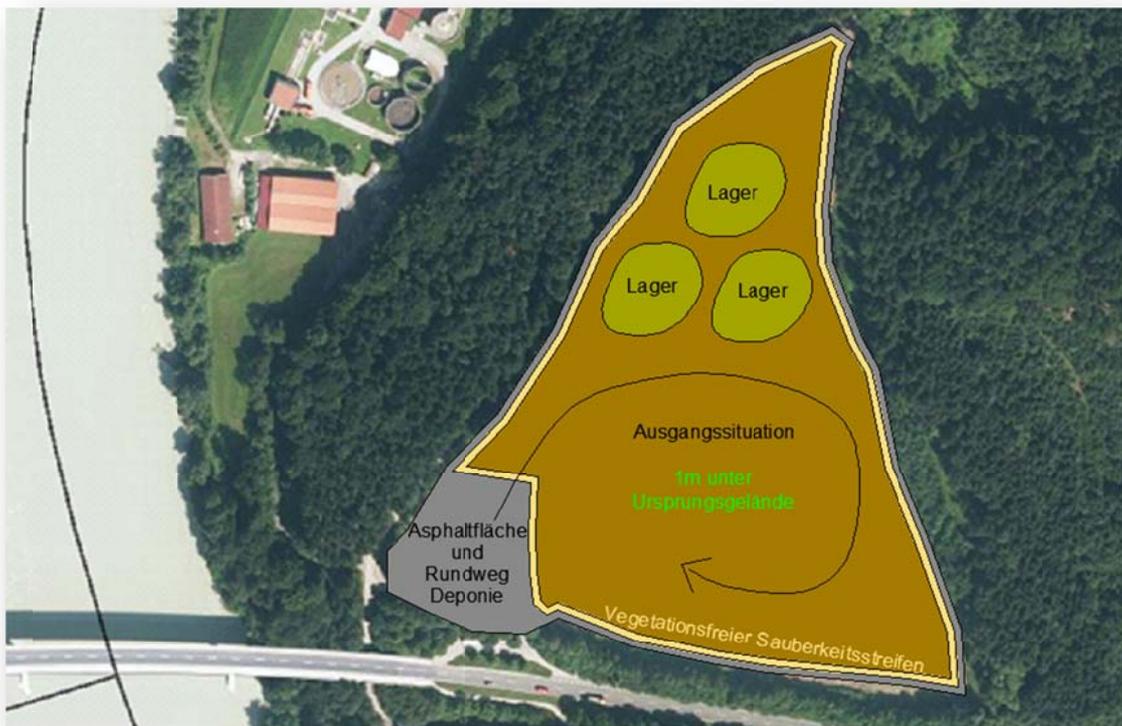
Schematische Grundriss-Darstellung nach einem der ersten Bauschritte „Deponie-Rundweg“
